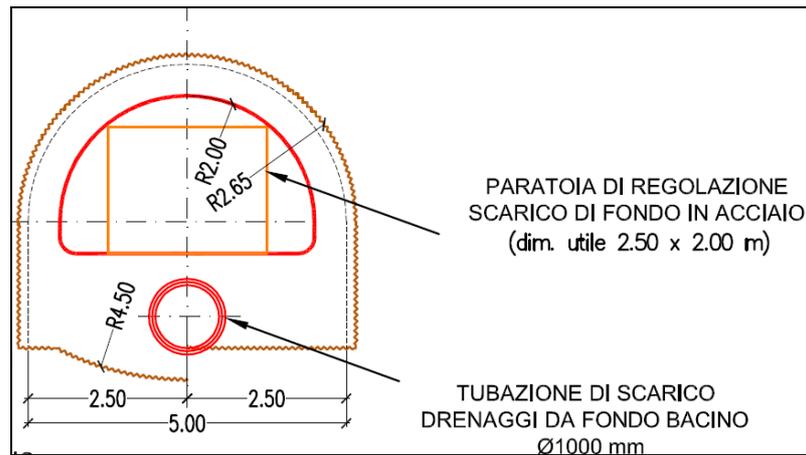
sezione longitudinale manufatto di presa dello scarico di fondo
